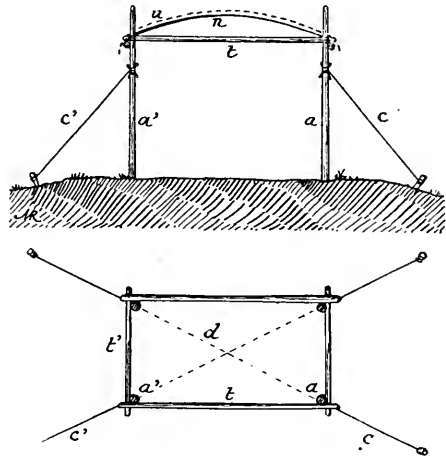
Élévation et plan de la charpente d'une tente rectangulaire (essai de restauration)
